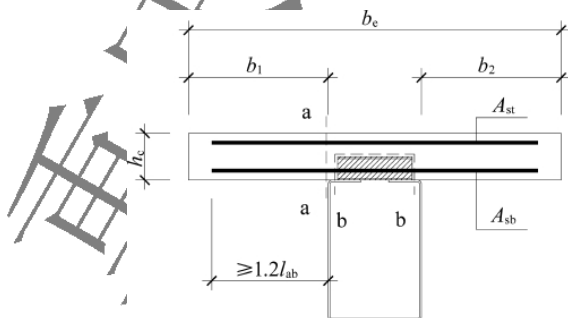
外包钢组合梁的混凝土翼板纵向受剪界面
